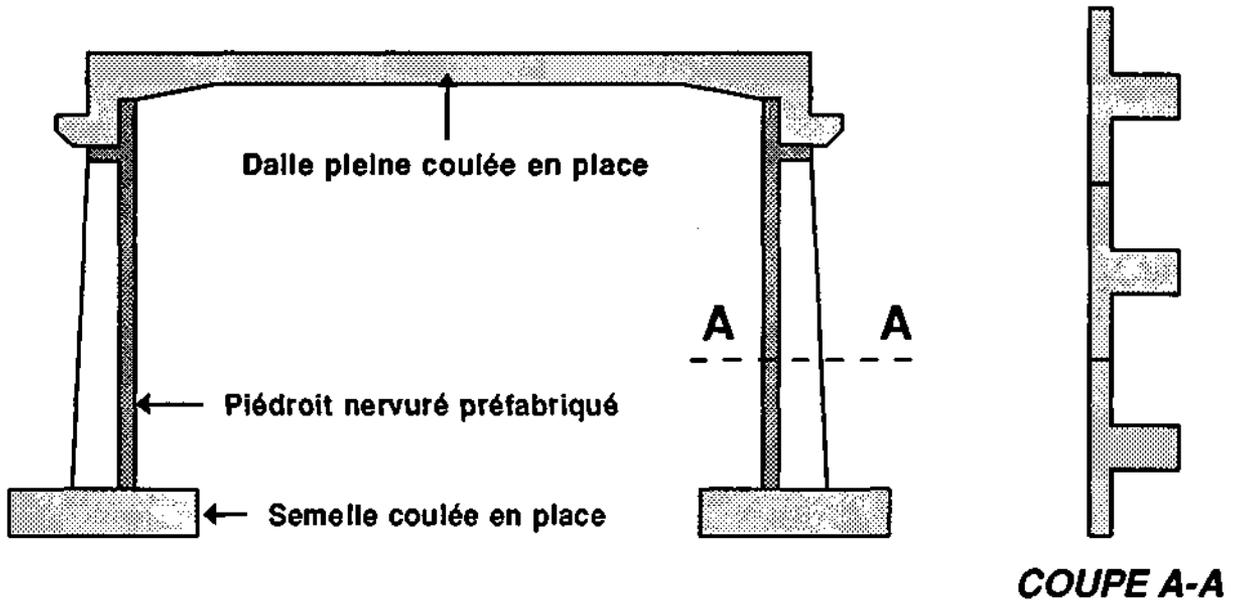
Assemblage entre des piédroits nervurés préfabriqués et des éléments coulés en place
